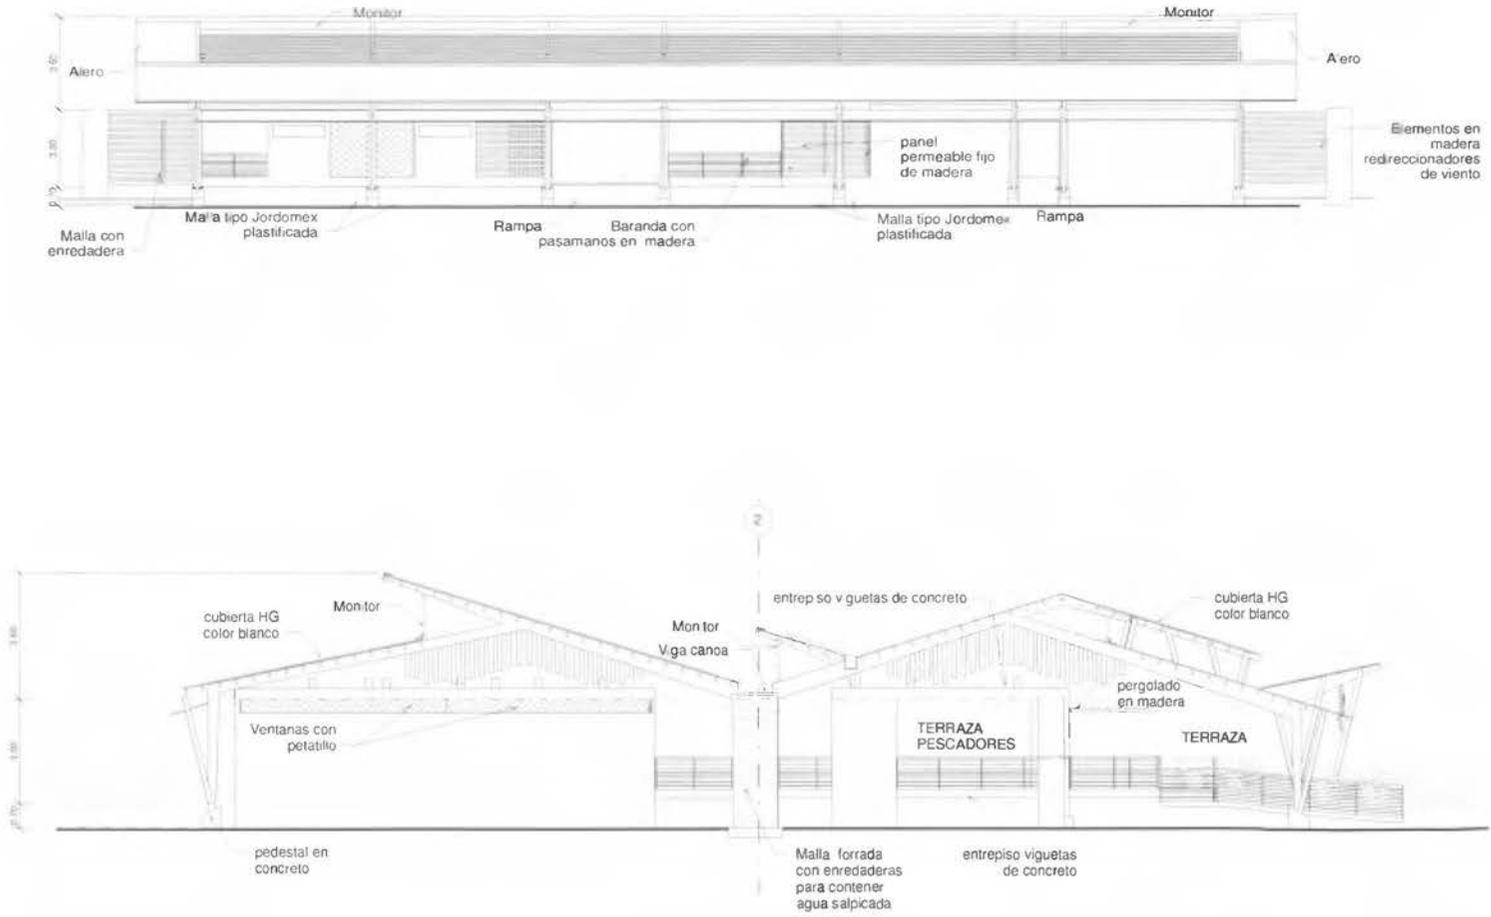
Fachada principal Oeste y fachada lateral Sur del edificio. Elaboradas por la autora.
